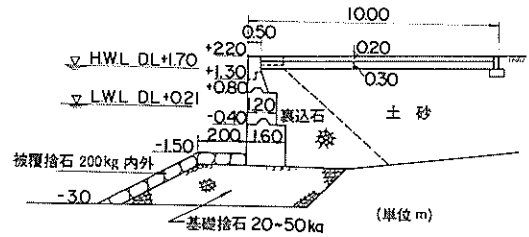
荻浜港小積物揚場 (-1.5 m) 標準断面図
